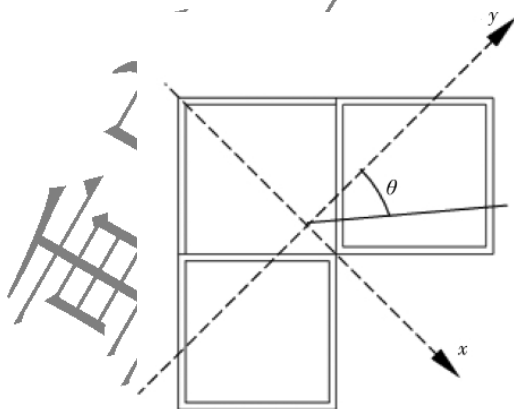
1 L 形钢管混凝土异形柱截面图
